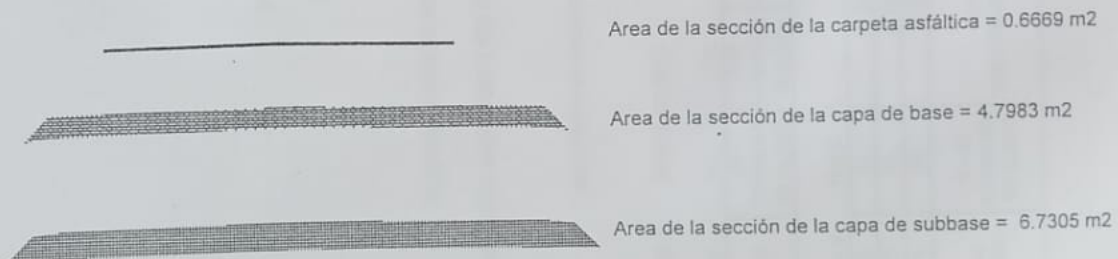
Áreas de sección de las capas del pavimento tradicional
